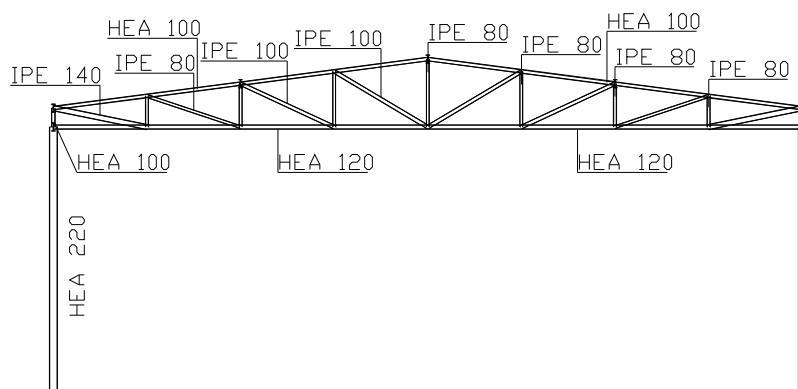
Pórtico com pilar de alma cheia, viga em treliça, vão de 20.00m, pilar em perfil com secção transversal HEA, viga em perfil com secção transversal HEA/IPE.
